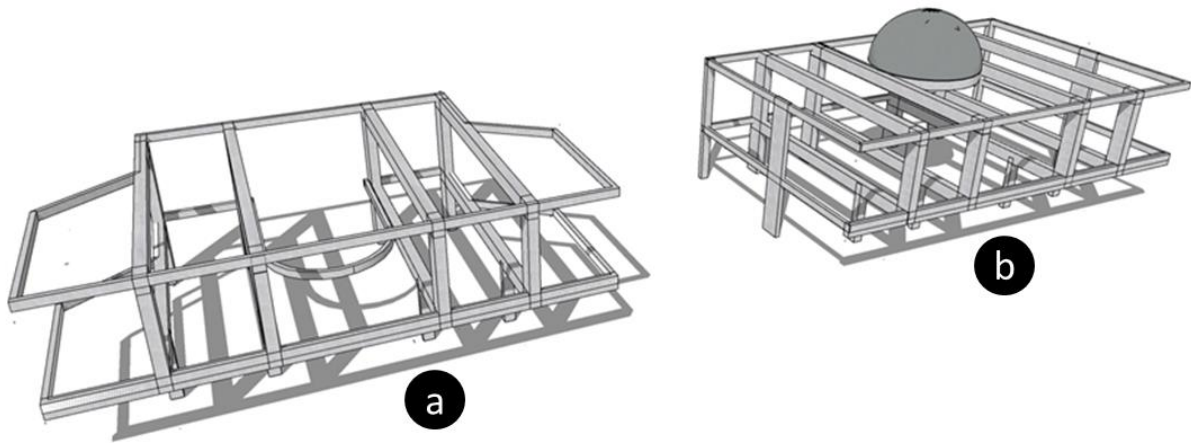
Esquema estructural del foyer a) en 1980; b) en 1982.
